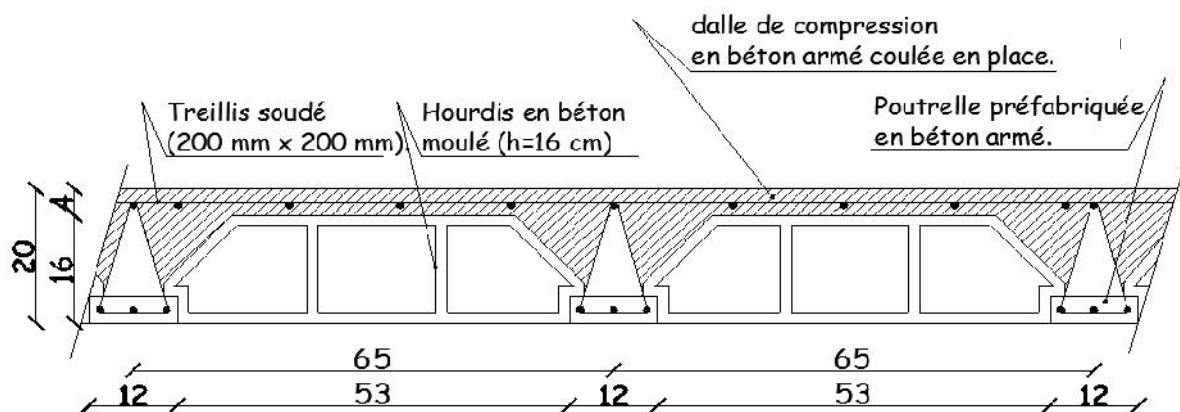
Plancher en béton armé avec poutrelles et hourdis
